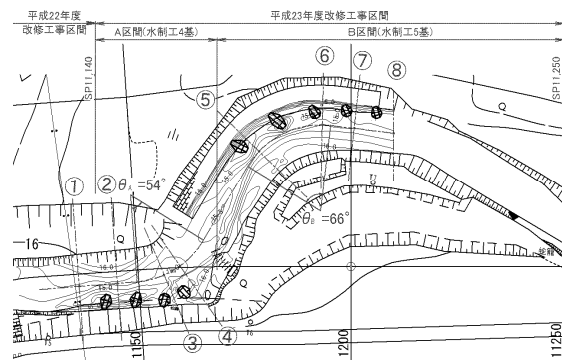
水制工配置図 (A 区間 4 基、B 区間 5 基)
